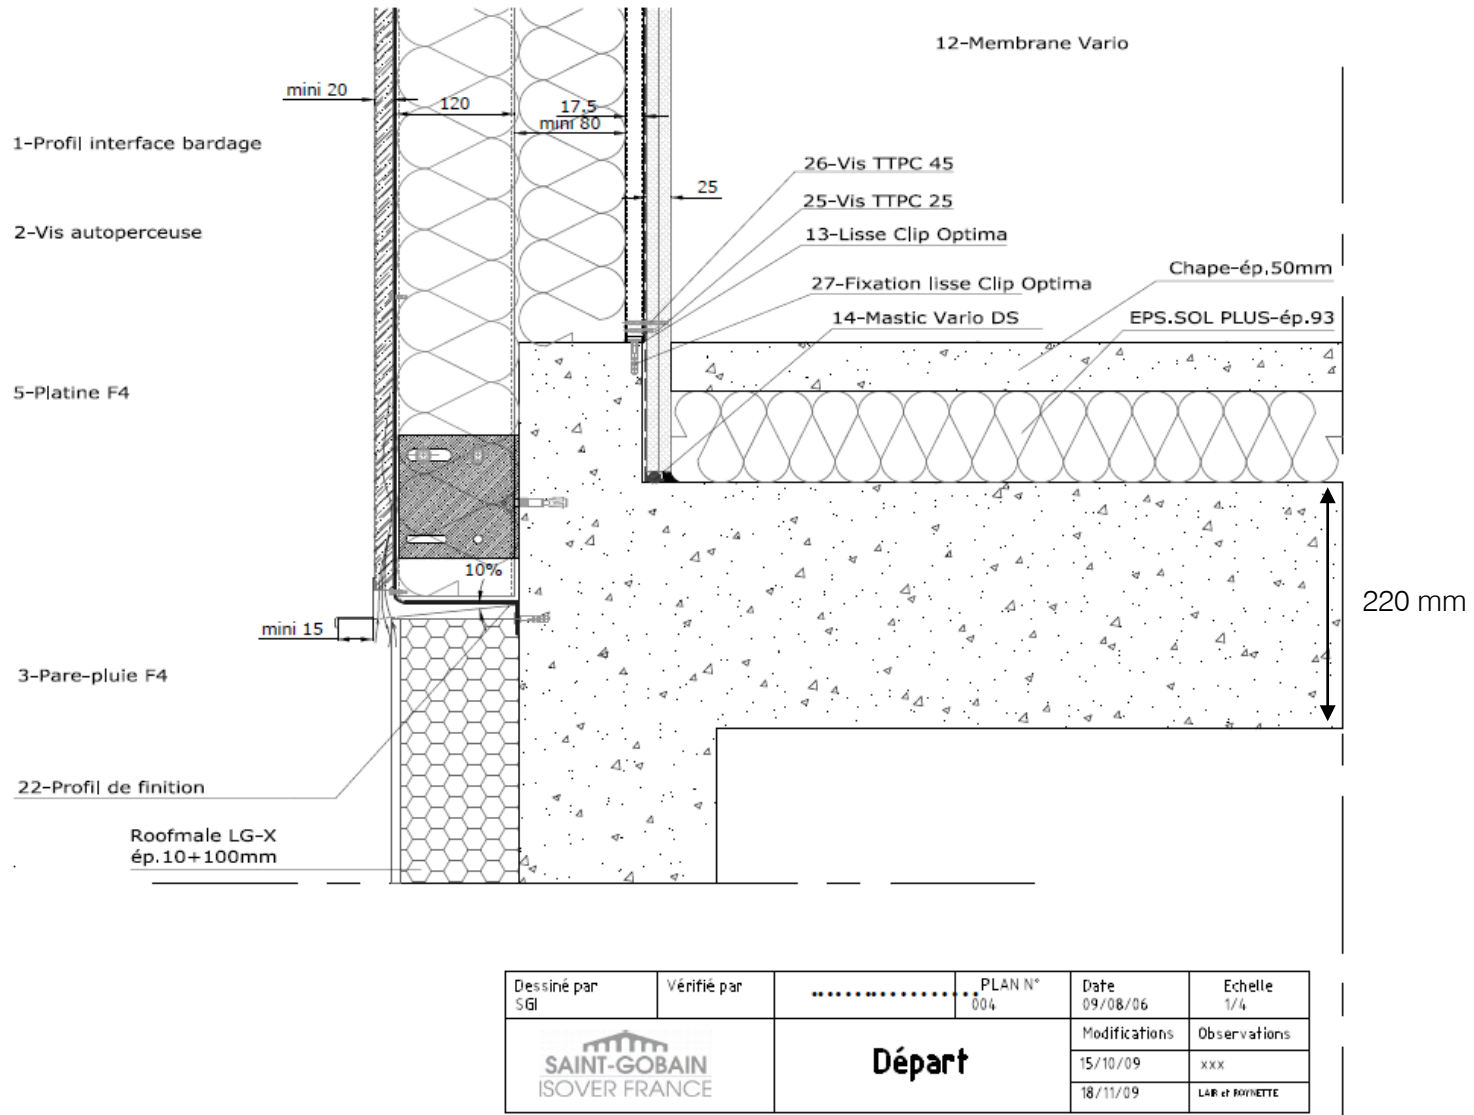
Configuration 5 – Liaison Façade F4 / Plancher bas isolé sous chape
